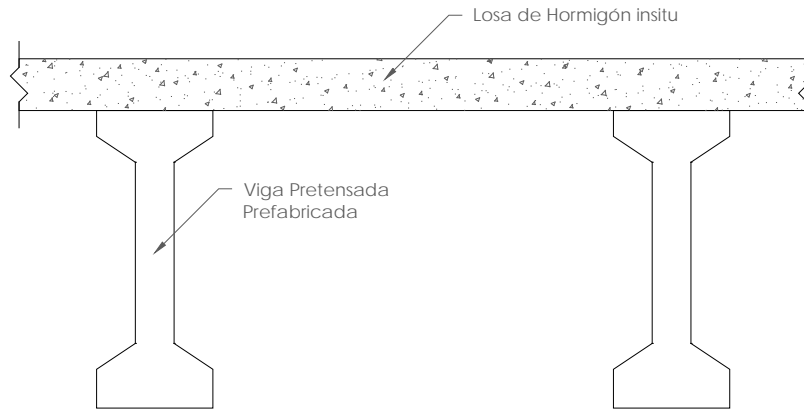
Losa hormigonada insitu en elementos pretensados
